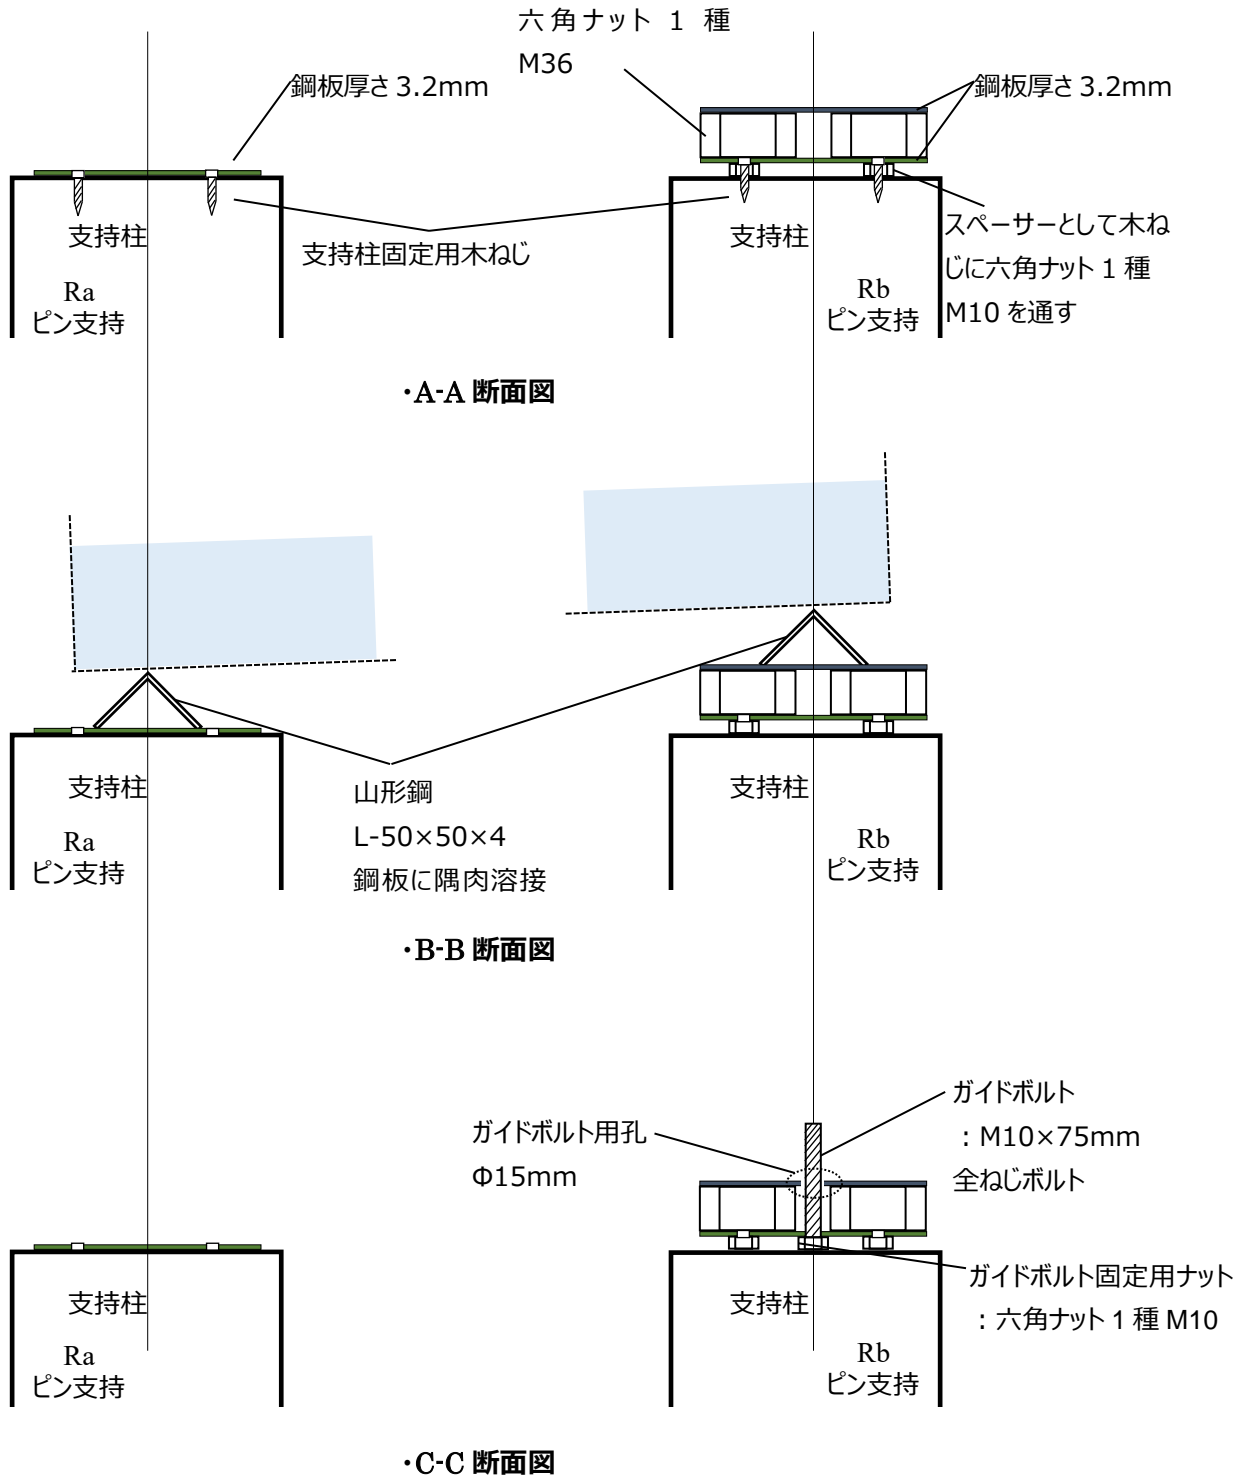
Ra、Rb 支点付近断面詳細図 (単位 : mm)
